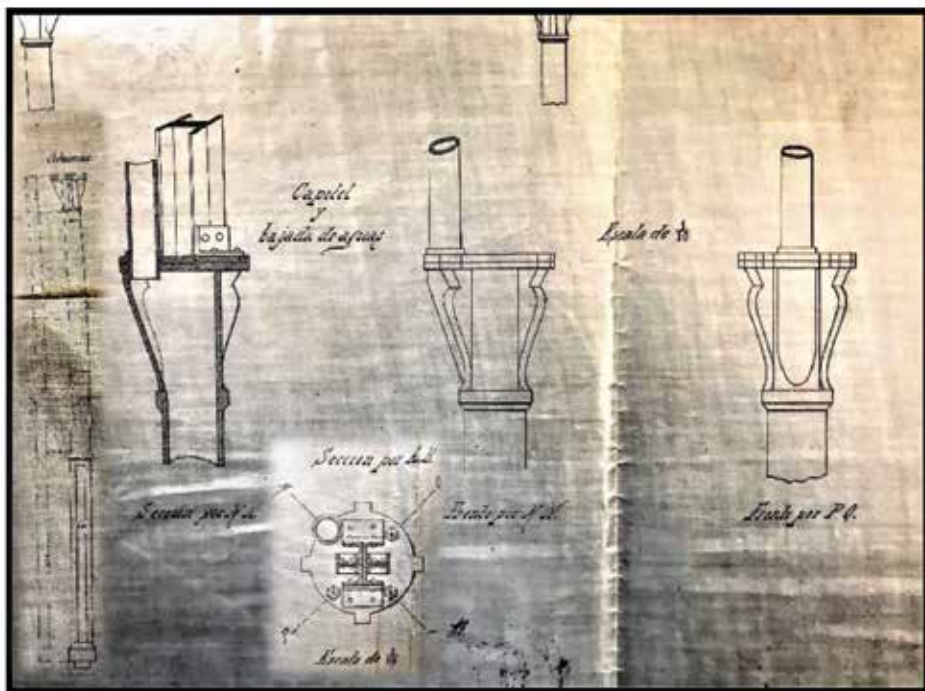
Planos de las columnas proyectadas para el levantamiento del edificio metálico. Fuente: (L.7-V. AHMB.)
